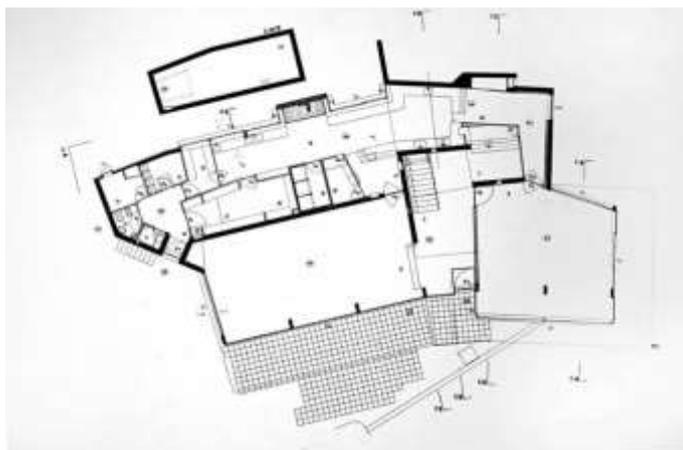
Planta do piso -1 da Casa de Chá da Boa Nova
